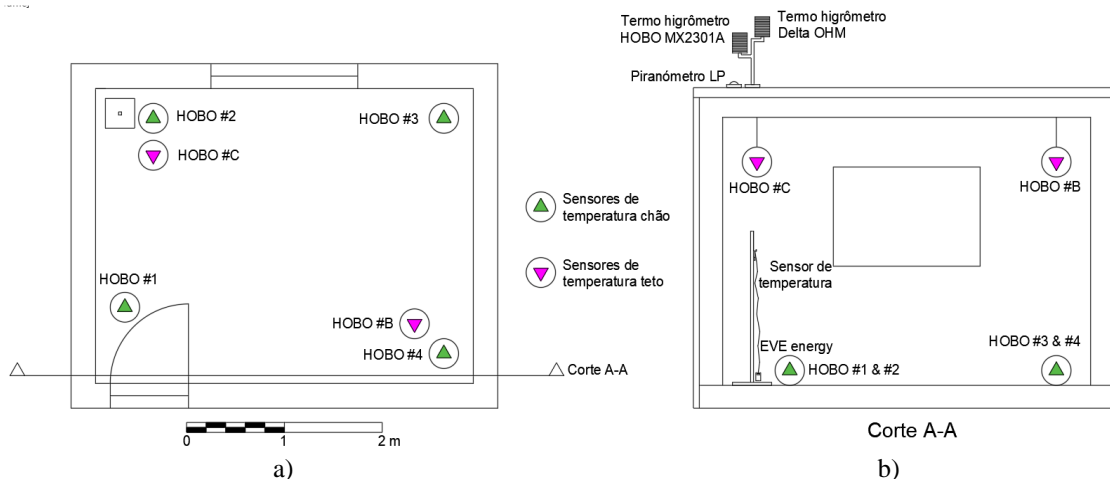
Distribuição da instrumentação na célula de teste. a) Vista em planta; b) Vista em corte
